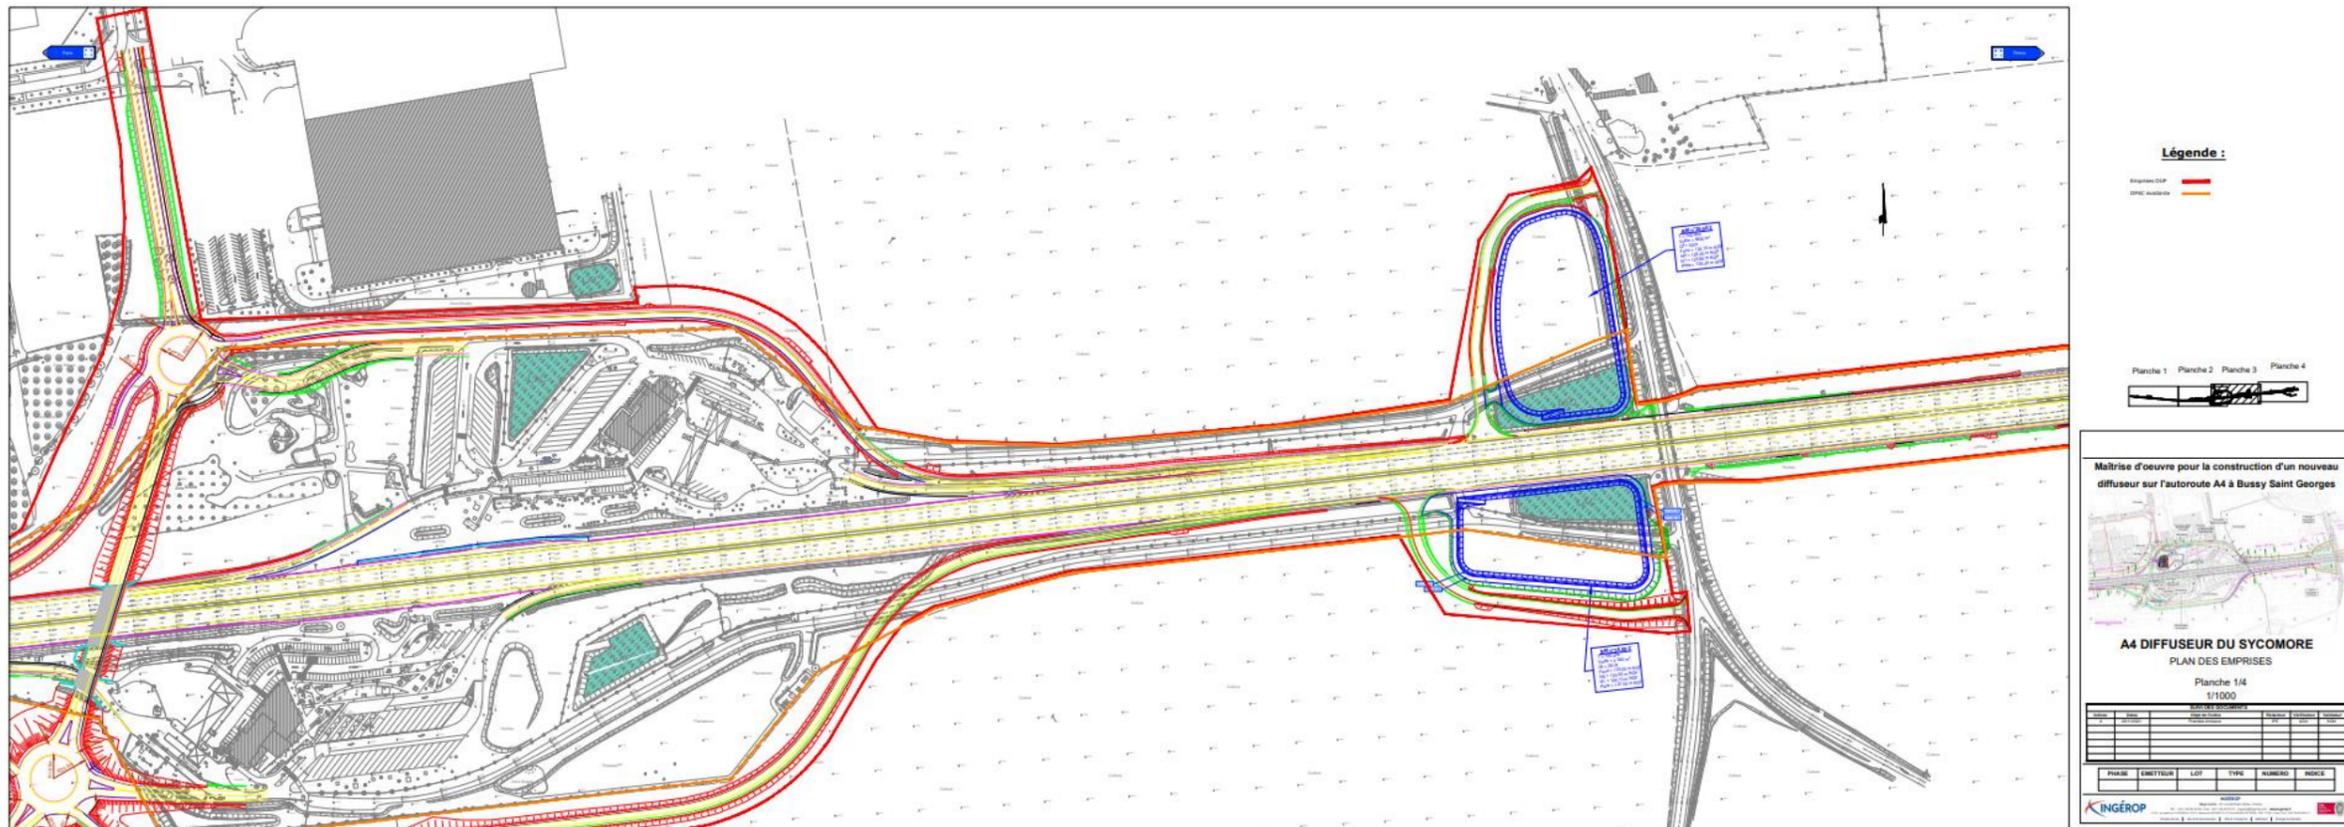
Plan des emprises travaux au droit du Parc d'activités Gustave Eiffel, commune de Bussy-Saint-Georges
